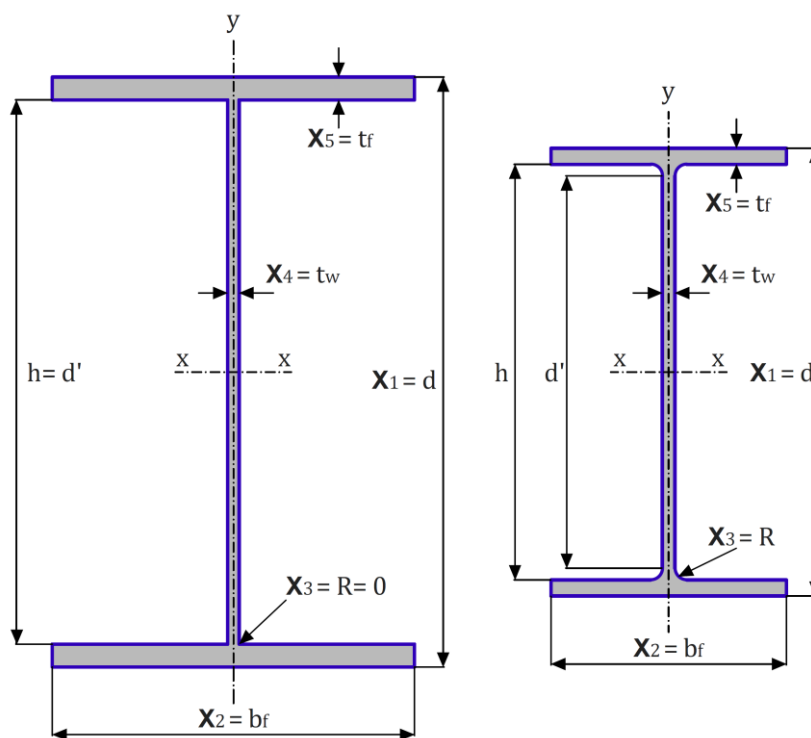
Variáveis de projeto geométricas em perfil soldado e laminado I e H, e o vetor X
